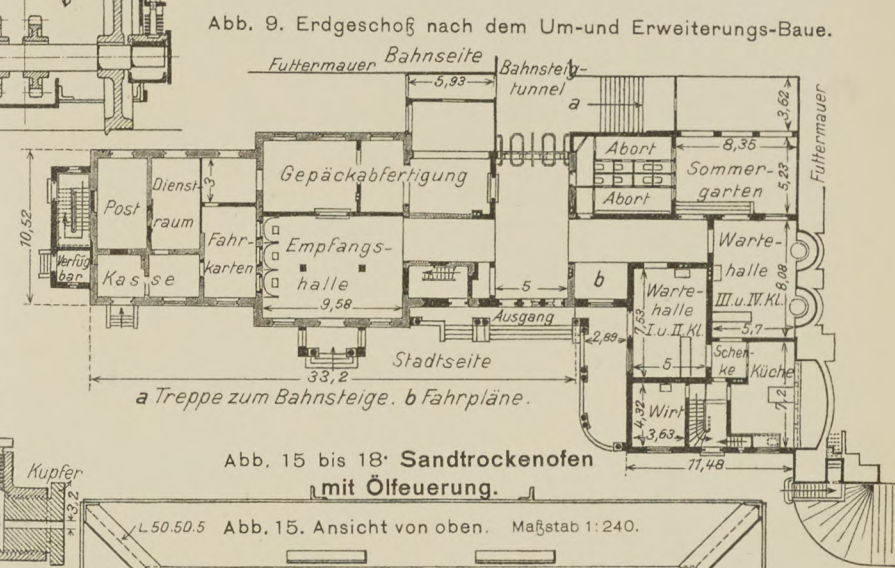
Erdgeschoß nach dem Um- und Erweiterungs-Baue
